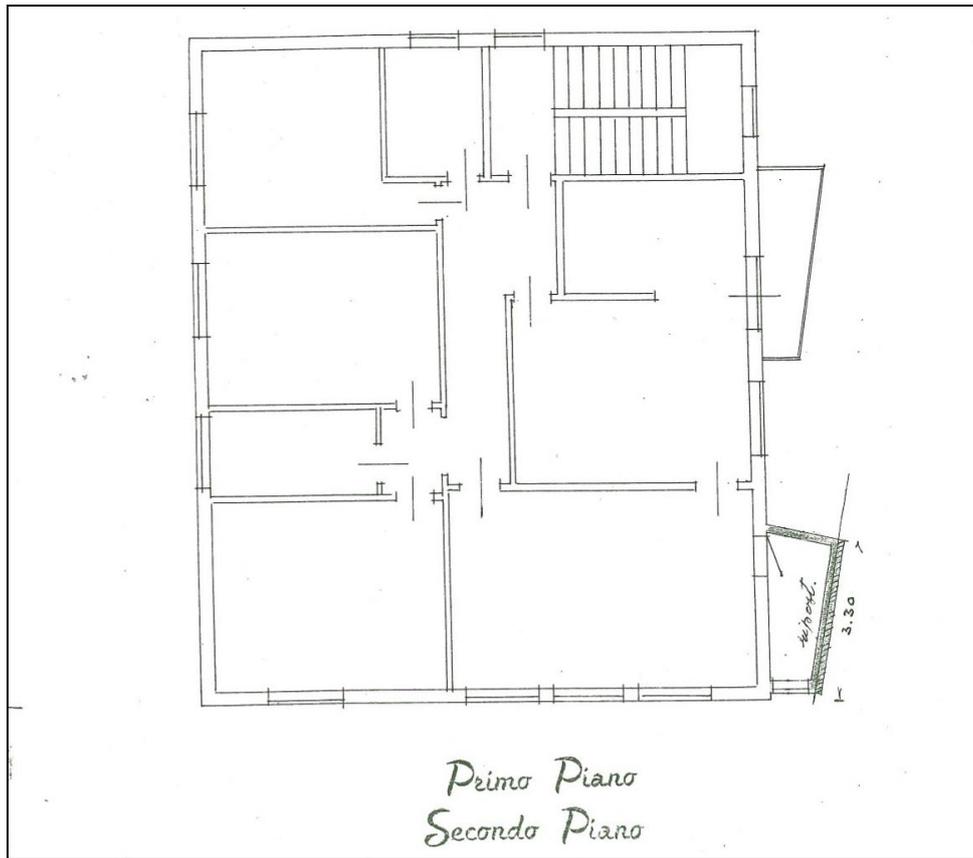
c. Stato approvato: Pianta Autorizzazione Edilizia n. 23117 del 18.10.1956.
